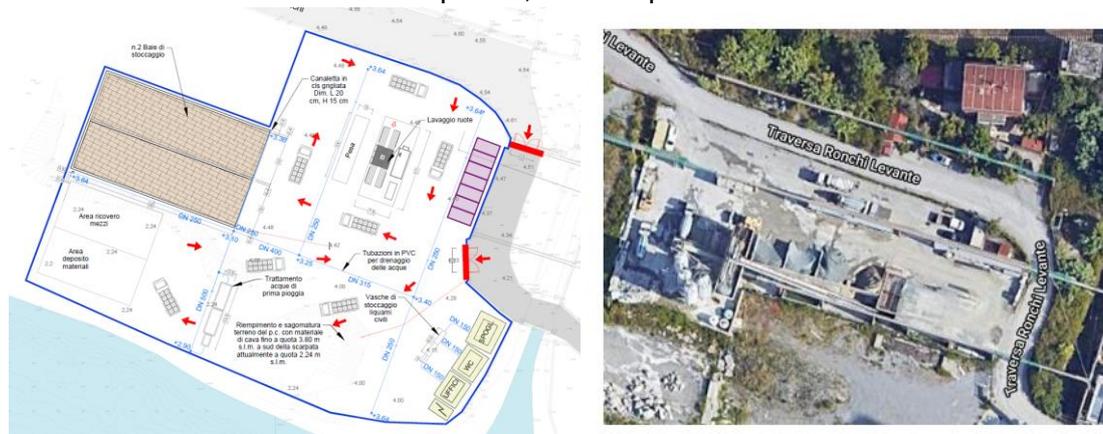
area di cantiere C4 – Layout di cantiere ed inquadramento territoriale
